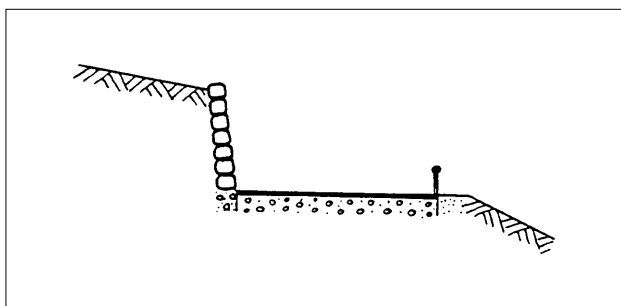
Mur de soutènement caractéristique en pierre naturelle:
